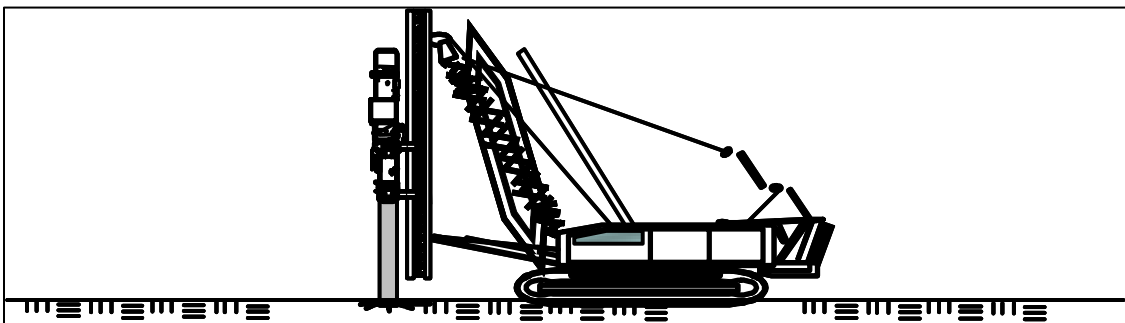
Detalle de Soltado del Pilote en la Resbaladera.
